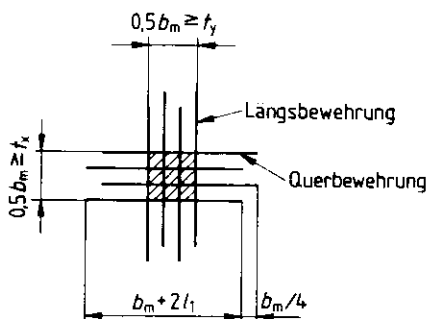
Zusätzliche Bewehrung unter einer Einzellast
